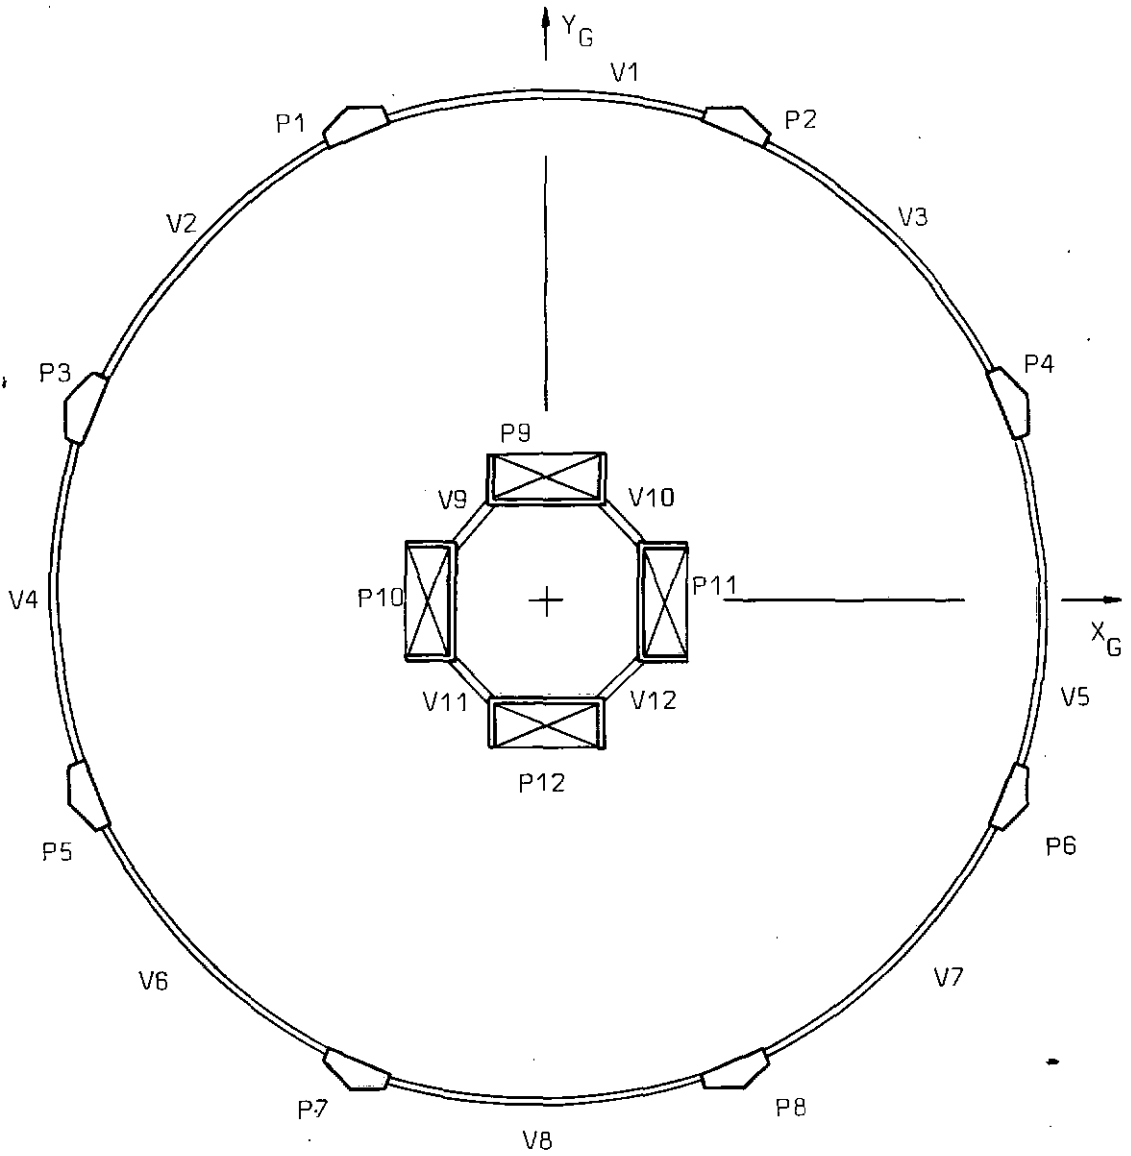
Esquema do pavimento tipo utilizado na série de exemplos 3
